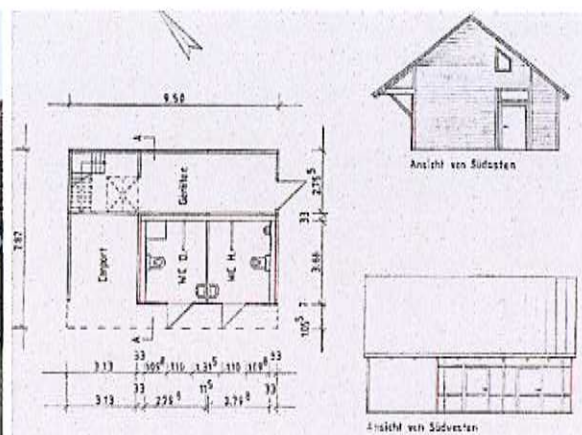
Grundriss des Sanitärgebäudes
